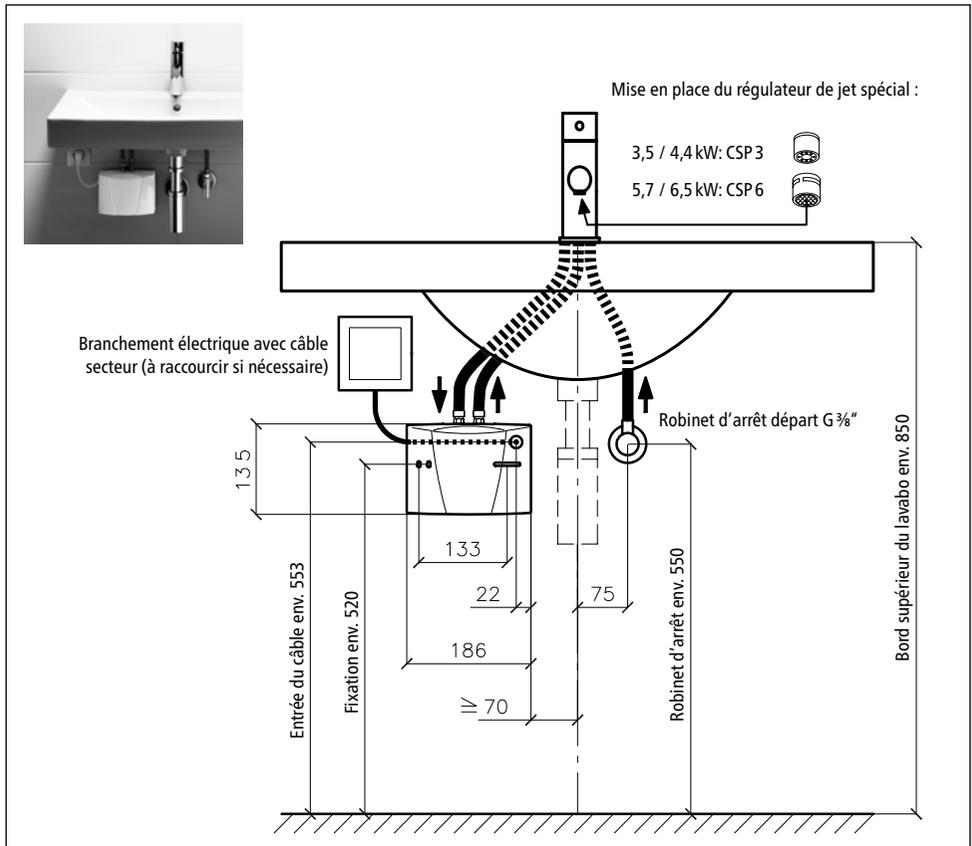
« Installation basse pression (écoulement libre) avec robinetterie pour appareils à eau chaude basse pression » (cotes en mm)
